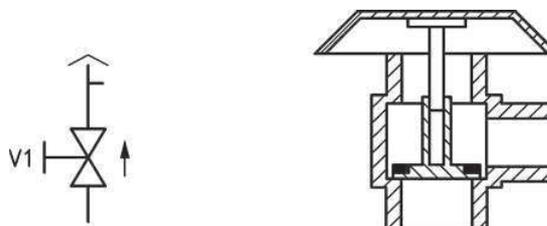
Sicherungsarmatur der Familie D, Typ A und Konstruktionsprinzip
